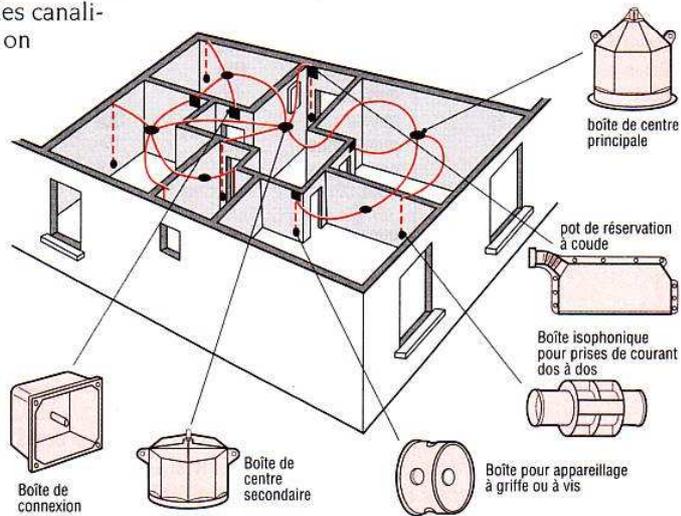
Exemple de disposition d'une installation en pieuvre.
